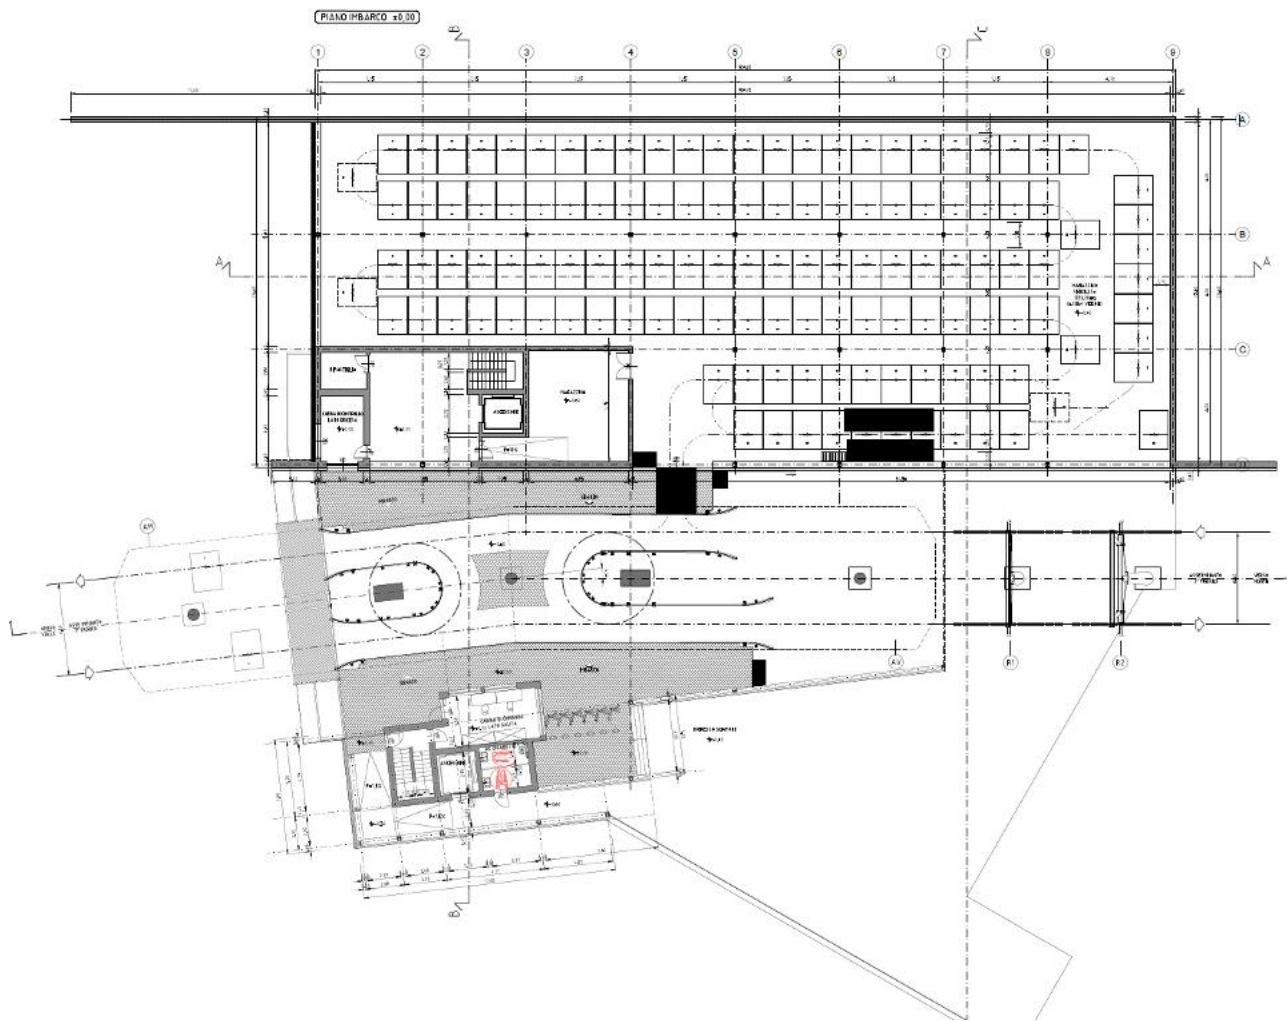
Pianta stazione intermedia nuova telecabina -scala a vista
